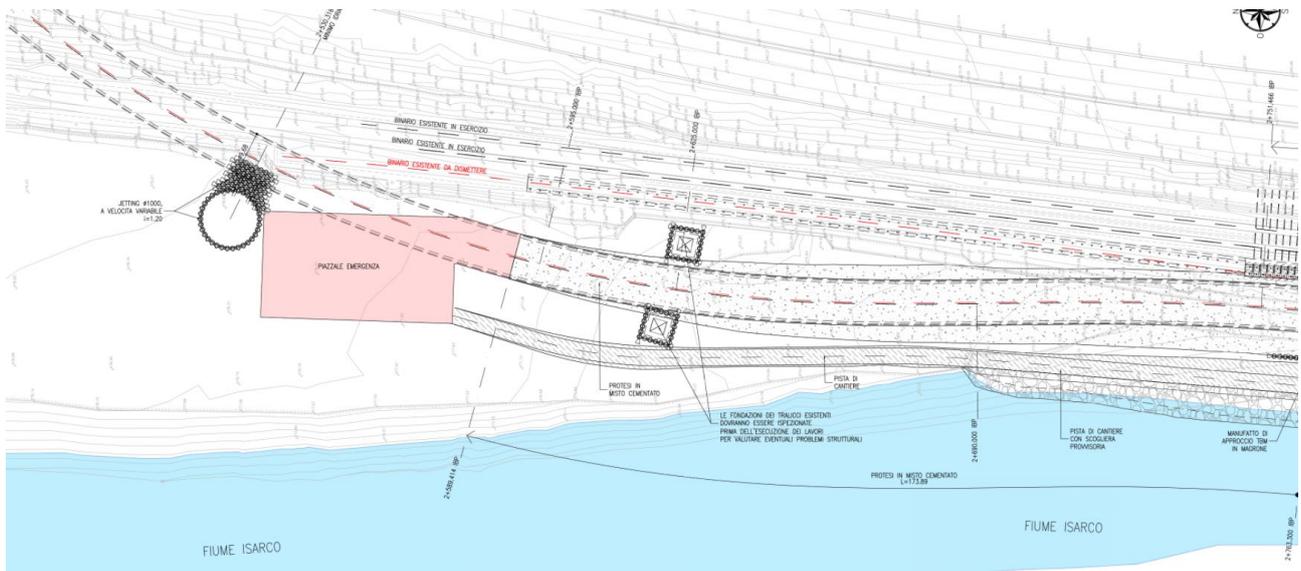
Inquadramento planimetrico della WBS GA08 – parte 1 : pozzo e tralicci Terna
